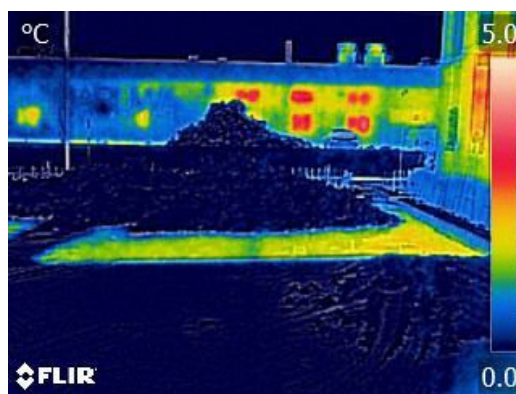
東面融雪状況①（敷設ピッチ 300 mm 融雪パターン②）
